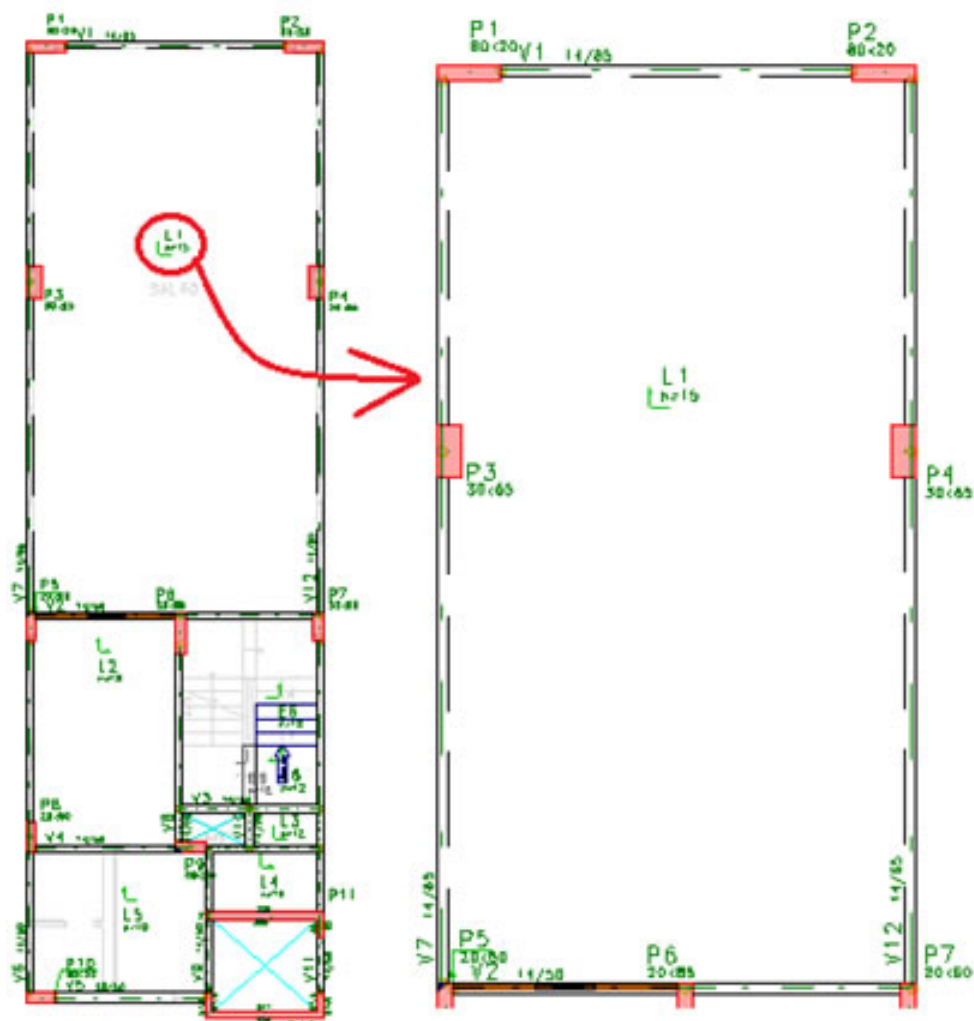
Pavimento e laje L1 a ser dimensionada e detalhada.
